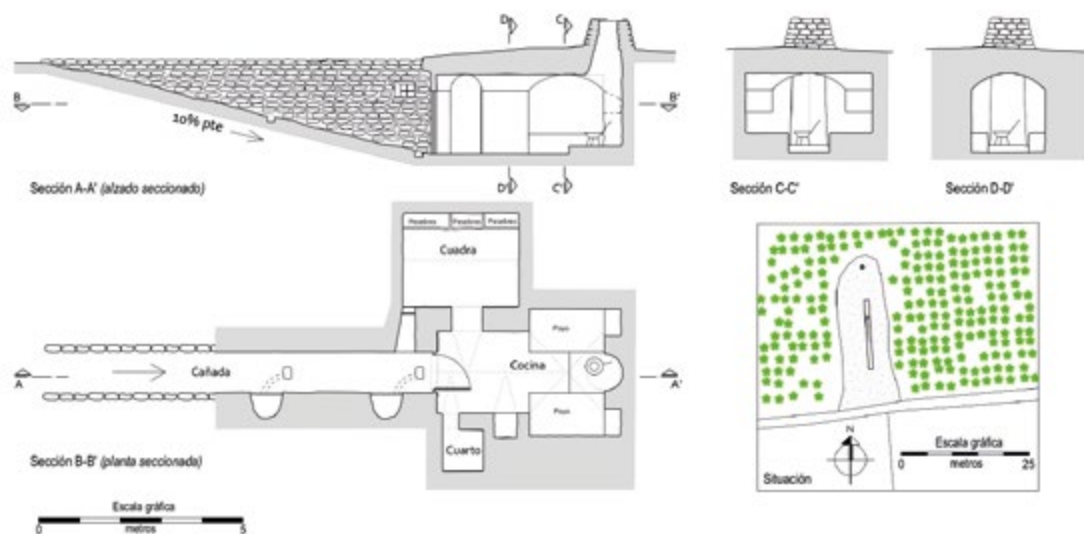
Planta, secciones transversales y longitudinal de la cueva de Casa Quemada II, Daimiel
